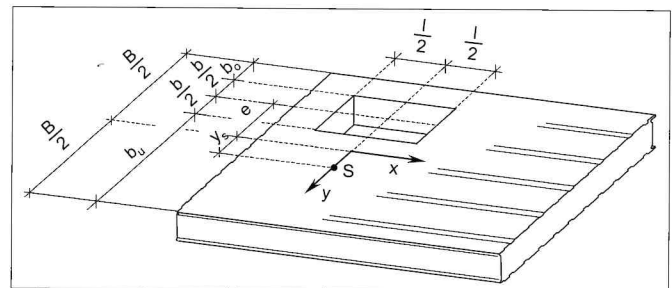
Wand-Sandwichelement mit rechteckiger Öffnung
